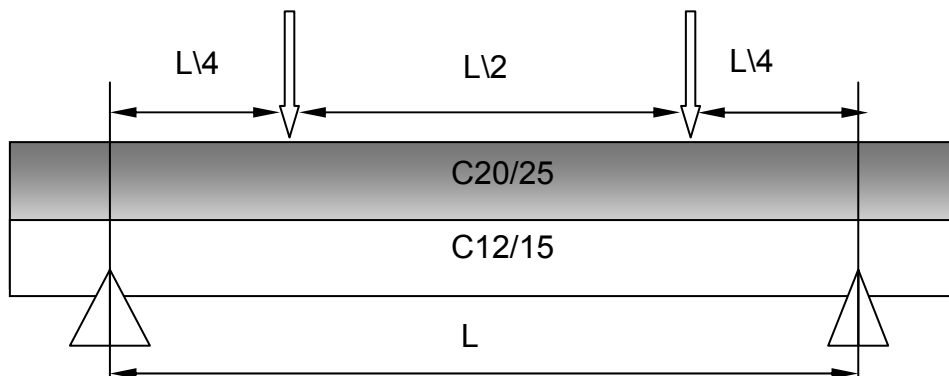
Розрахункова схематична схема досліджуваних бібетонних армованих балок
